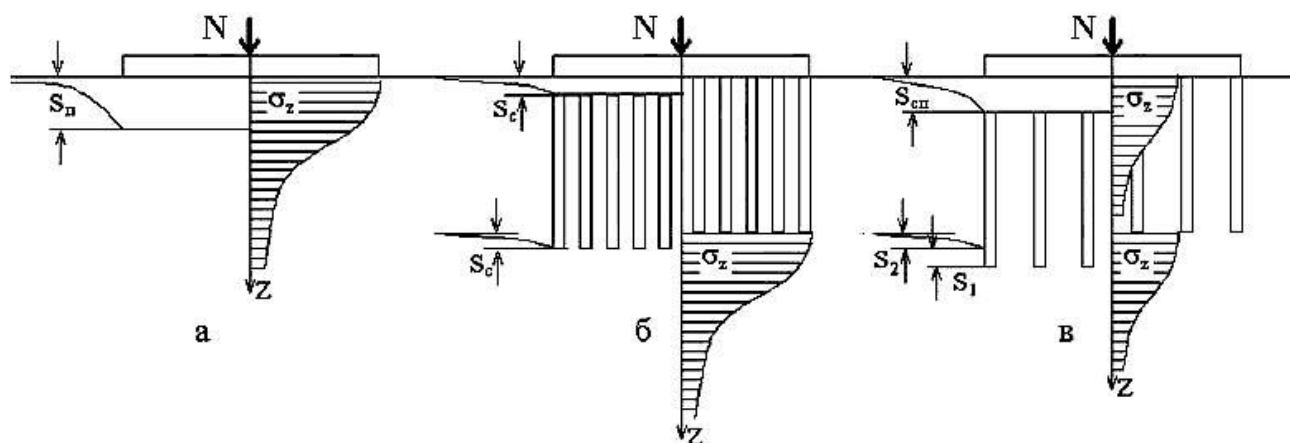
Варианты фундаментов: а – плитный; б – свайный; в – плитно-свайный.
